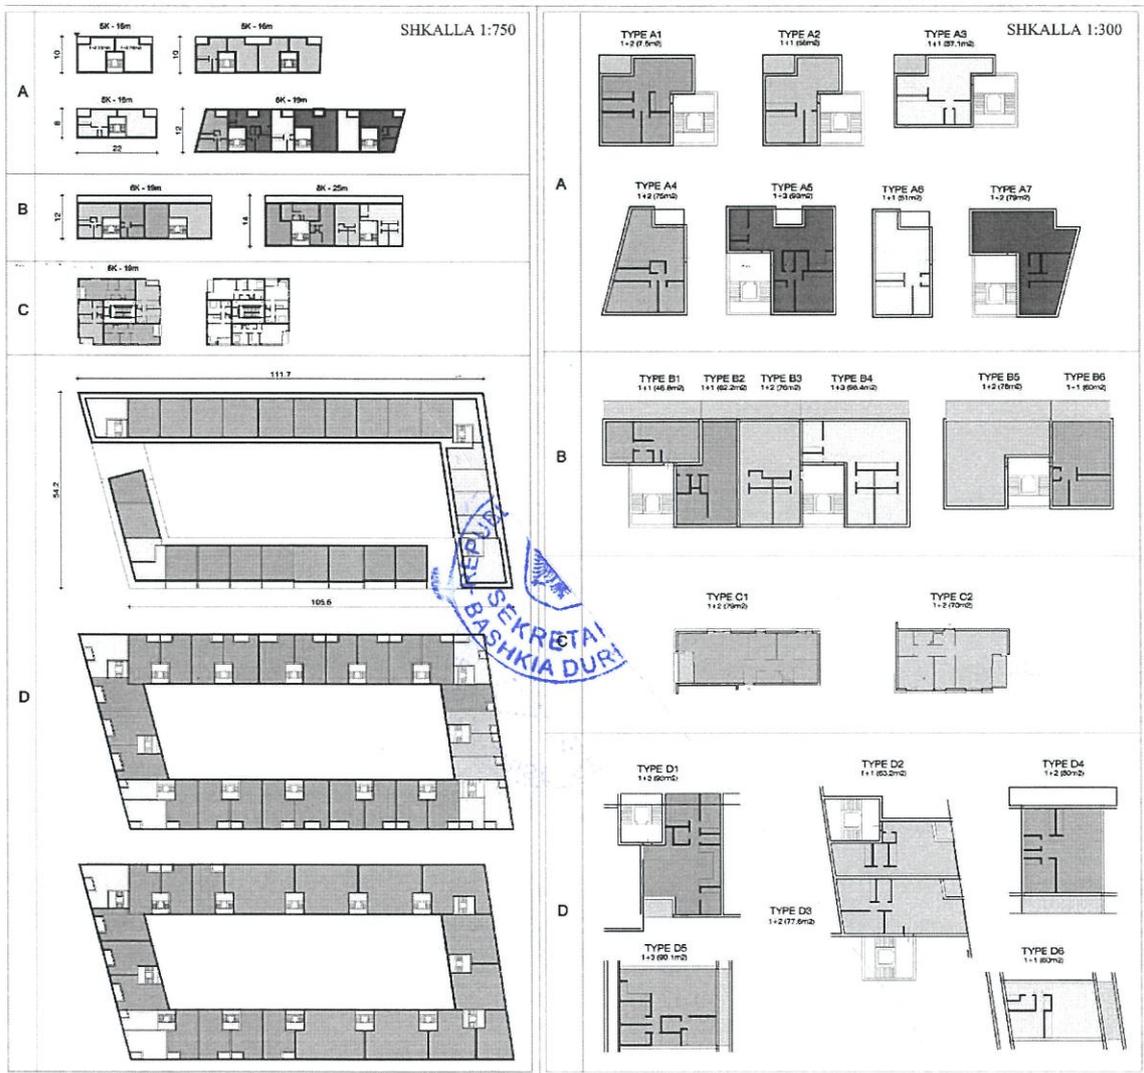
Zgjidhje planimetrike të objekteve të propozuara
